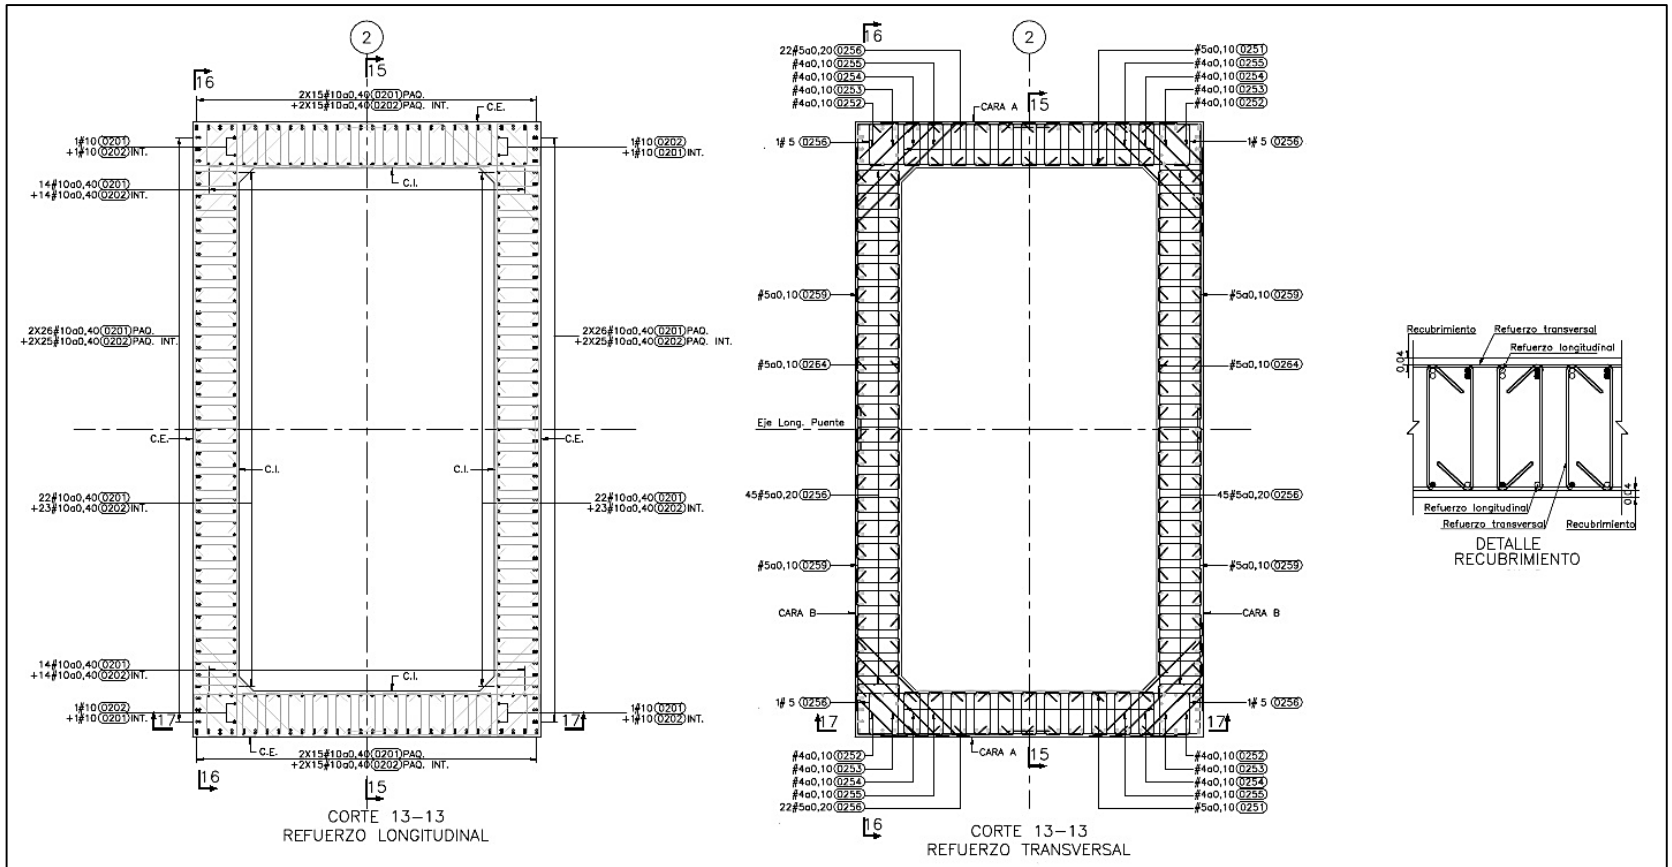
Sección Transversal Inferior para pilas con refuerzo longitudinal y transversal.
